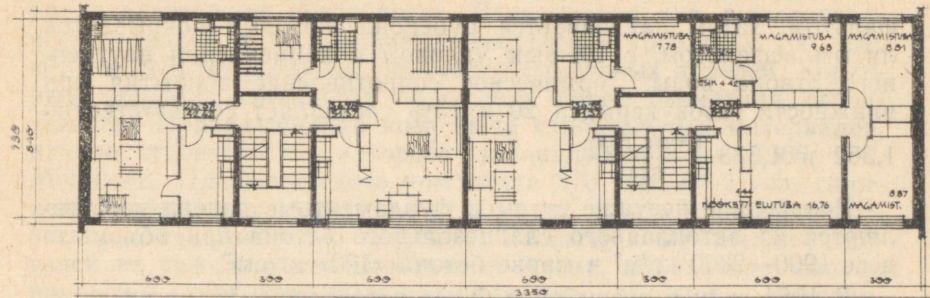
План 12-квартирного экспериментального жилого дома из сланце-золянобетонных деталей.
